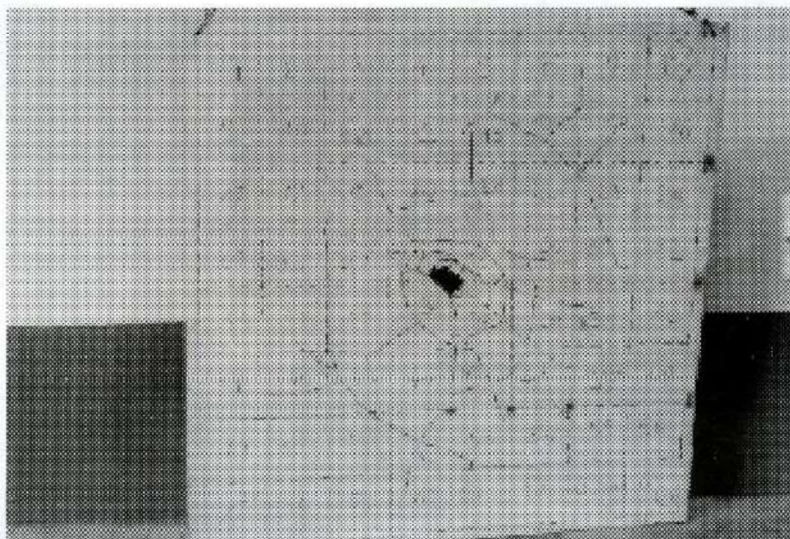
Fissuration - face inférieure, Modèle M45
